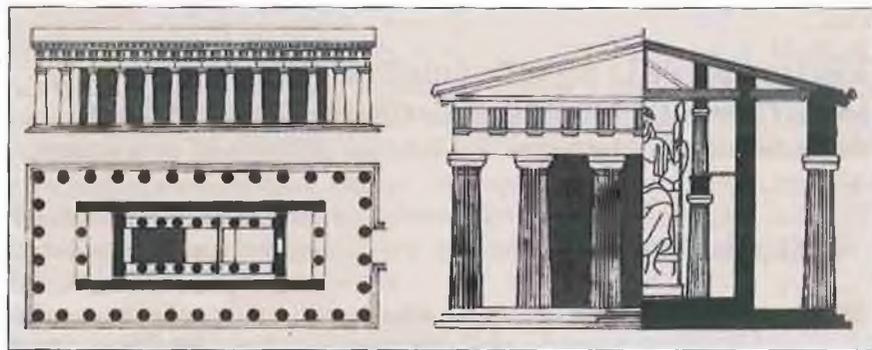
Planta y alzado del templo de Zeus, Olimpia.
